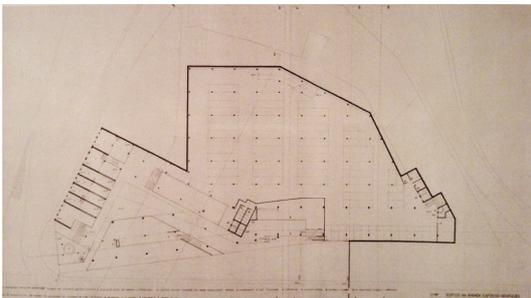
Proposta de Álvaro Siza para o edifício nascente, da Avenida da Ponte, planta de 1968
